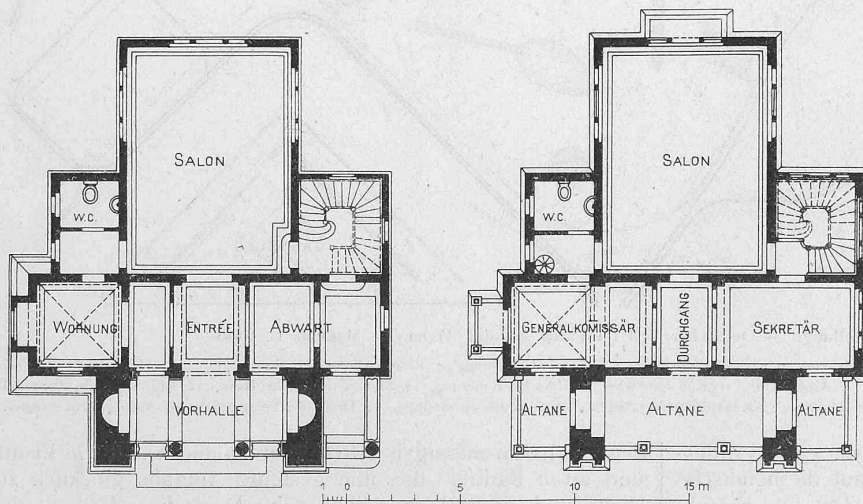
Grundrisse vom Erdgeschoss und Obergeschoss. — Masstab 1 : 300.
